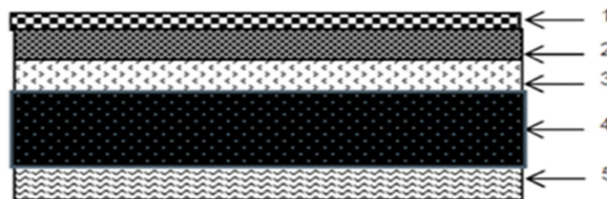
coupe verticale d'un plancher dalle pleine
